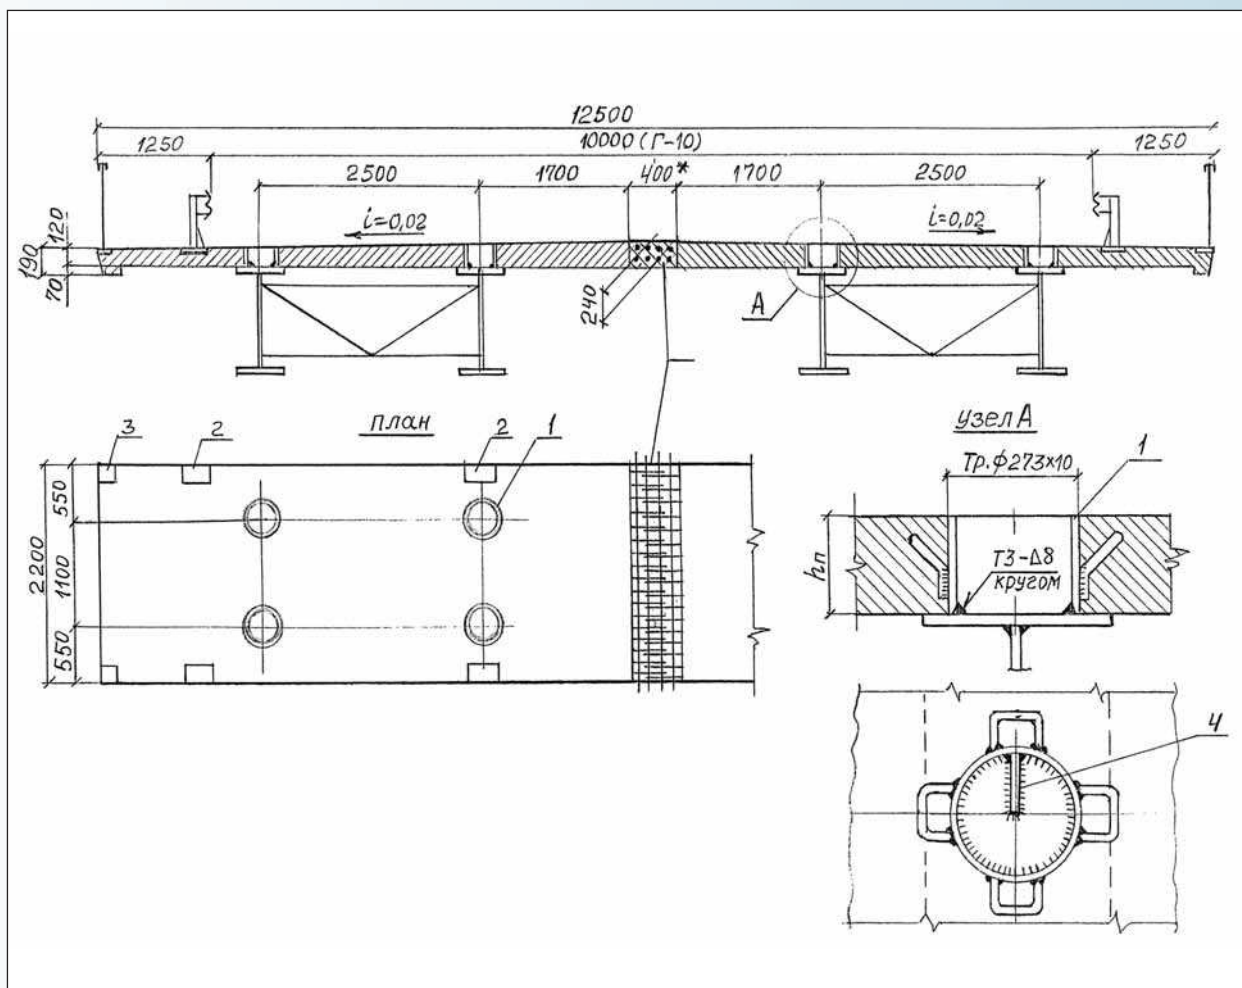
Конструкция сборных железобетонных плит и объединение их с металлическими балками сваркой: 1 – закладная деталь из трубы диаметром 273×10 мм; 2 и 3 – закладные детали объединения плит в поперечных стыках; 4 – продольный упор
